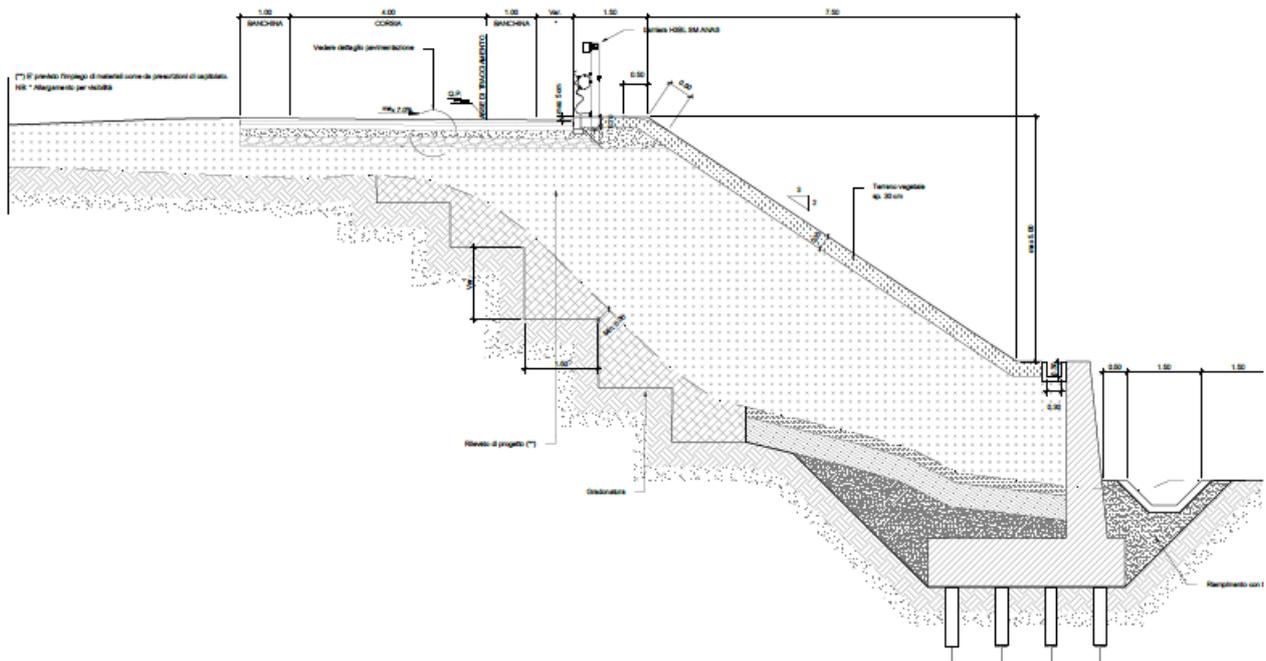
Sezione tipo rampa monodirezionale con muro di sotto scarpa (Rampa C)
